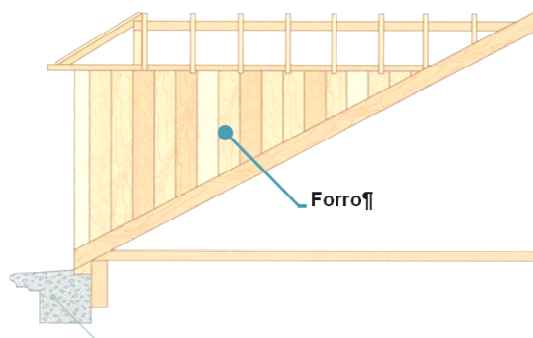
Estrutura de trapeira com forro de tabuado para ser posteriormente revestido a telha (Appleton, 2003) .
